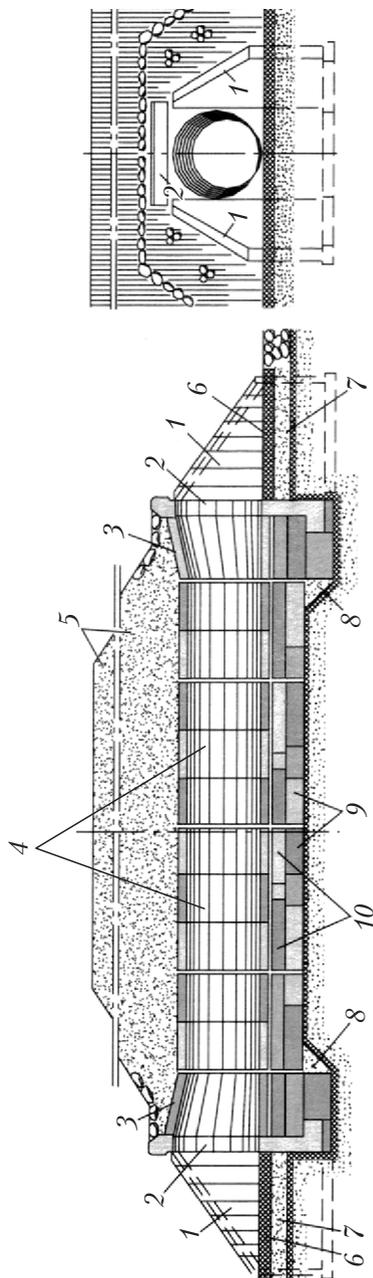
Конструкция типовой сборной железобетонной трубы:
